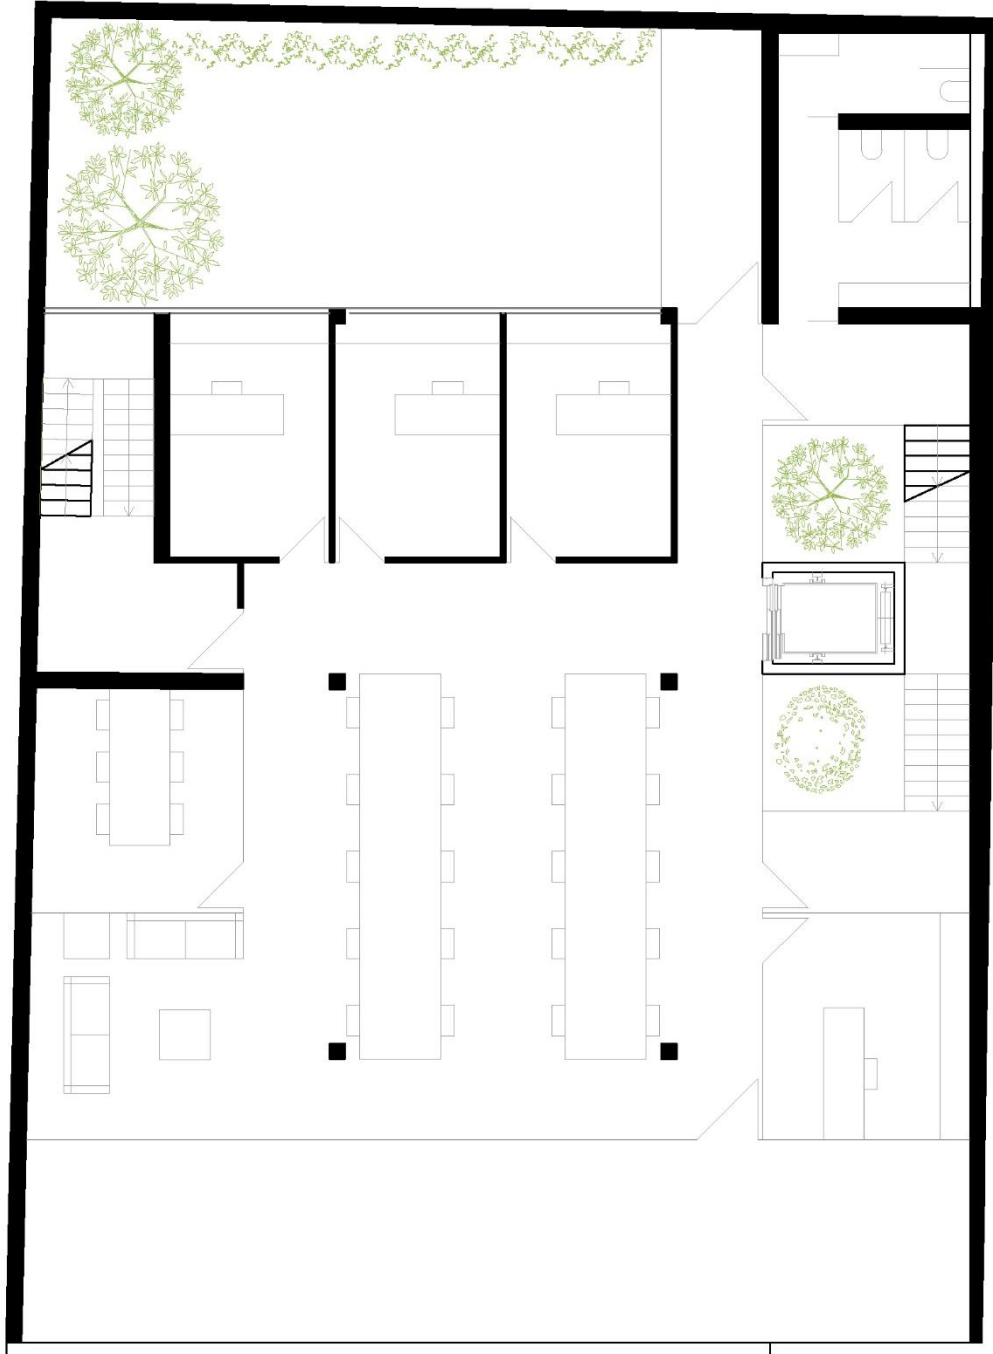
Encaje de proyecto, planta 5. Fuente: Elaboración propia.
